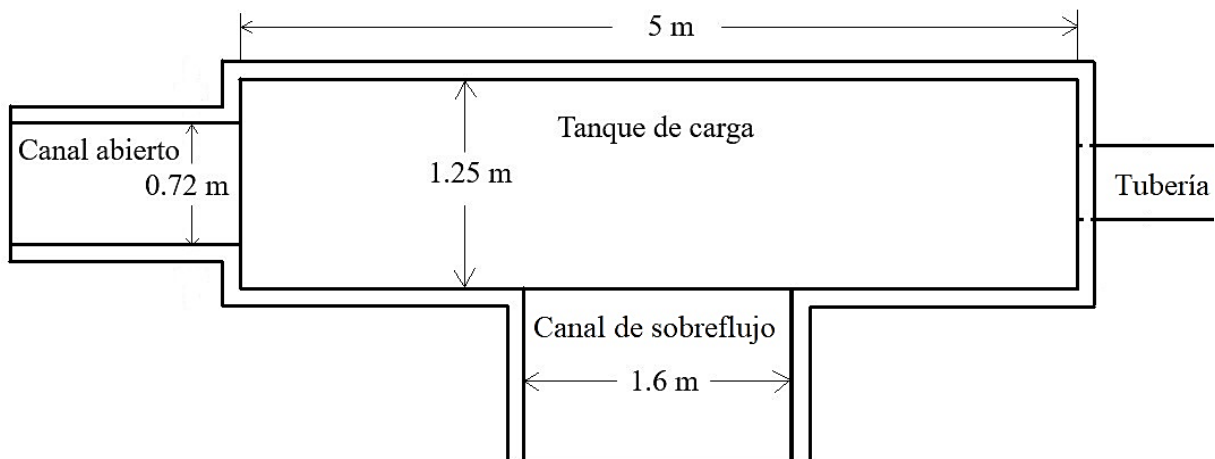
Dimensiones del tanque de carga mediante vista superior.
